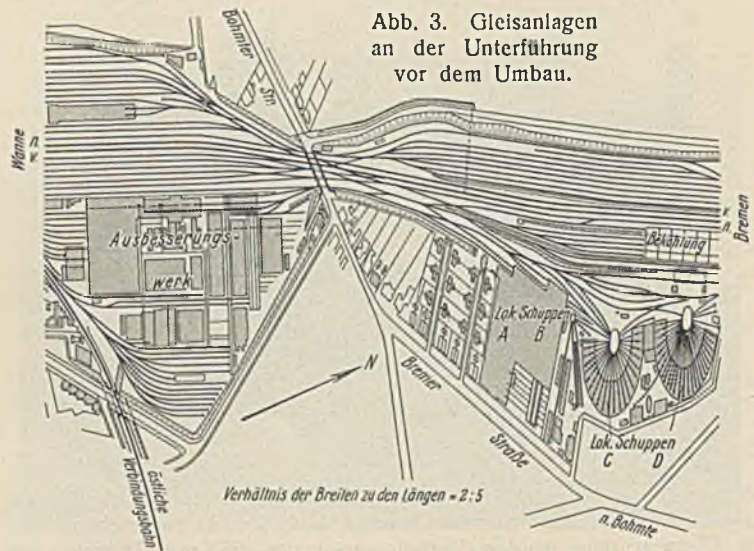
Gleisanlagen an der Unterführung vor dem Umbau.
